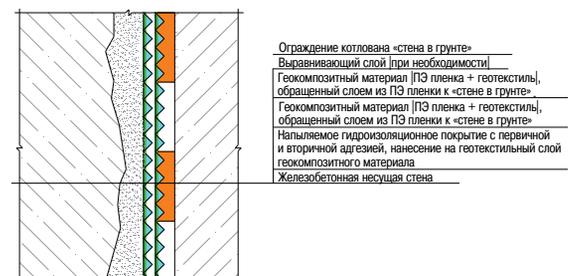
Устройство гидроизоляционной системы при открытом способе работ без пазух для обратной засыпки грунтом. Узел 1
